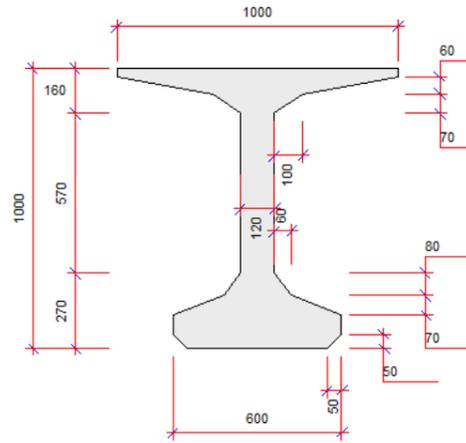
Viga prefabricada DT-ALV-100-100. Cotas en cm
